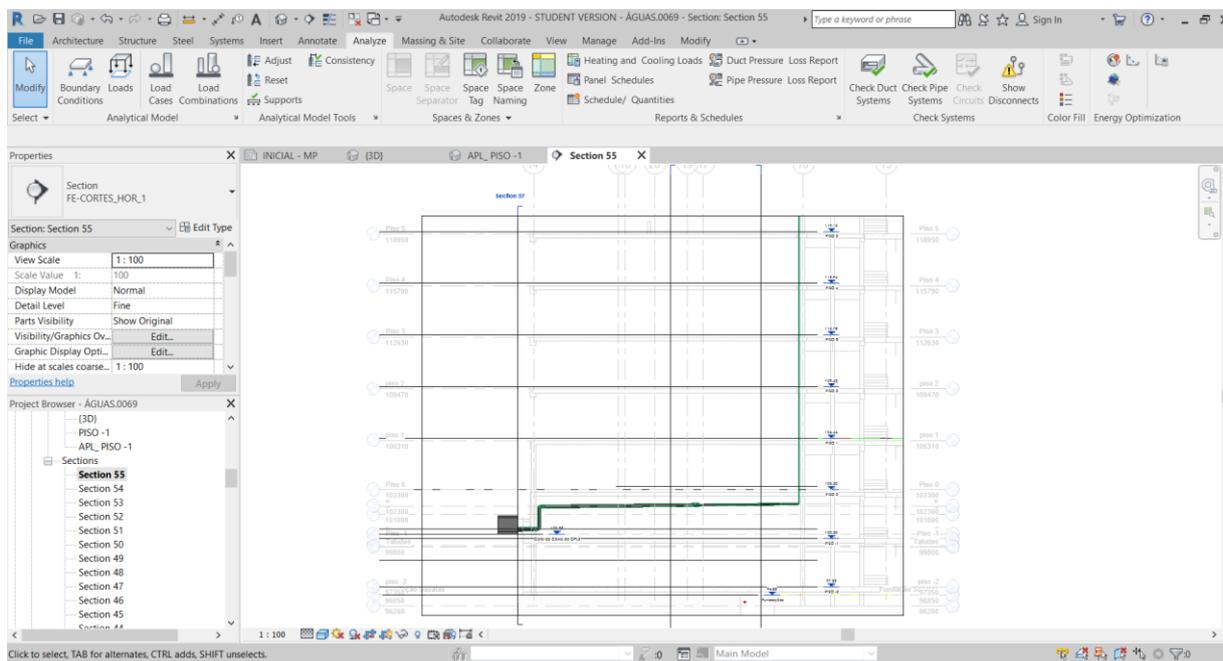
Pormenor da ligação da tubagem à caixa (autor).
